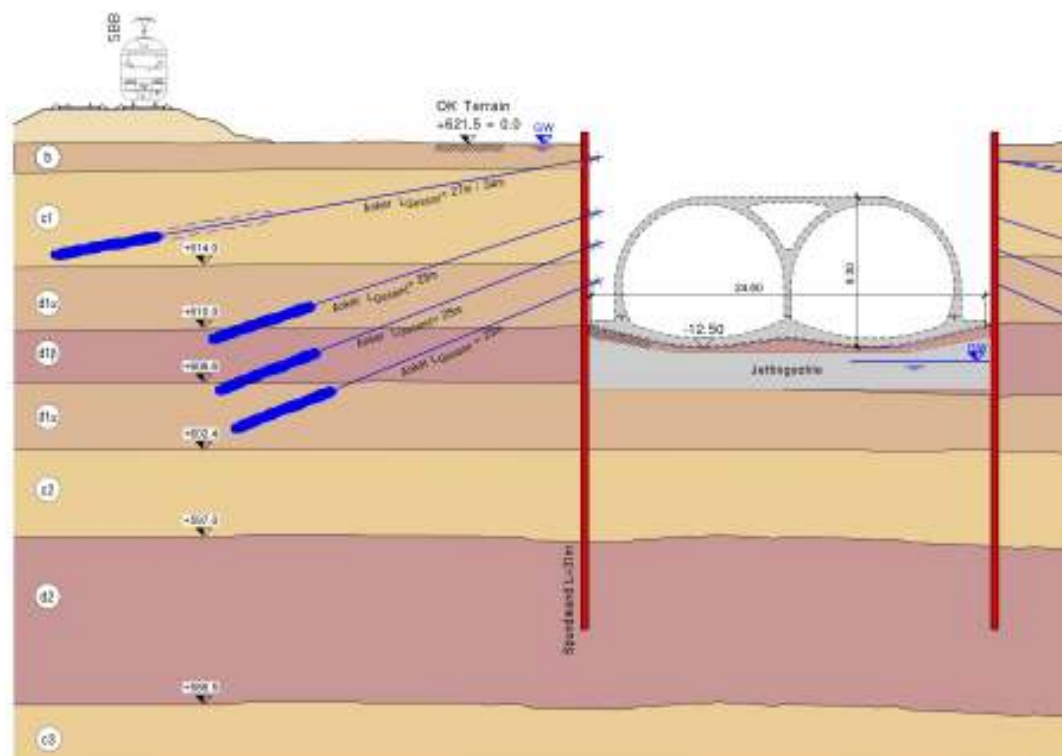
Baugrubenkonzept mit Jettingsohle im Baugrubenabschnitt Portal West
